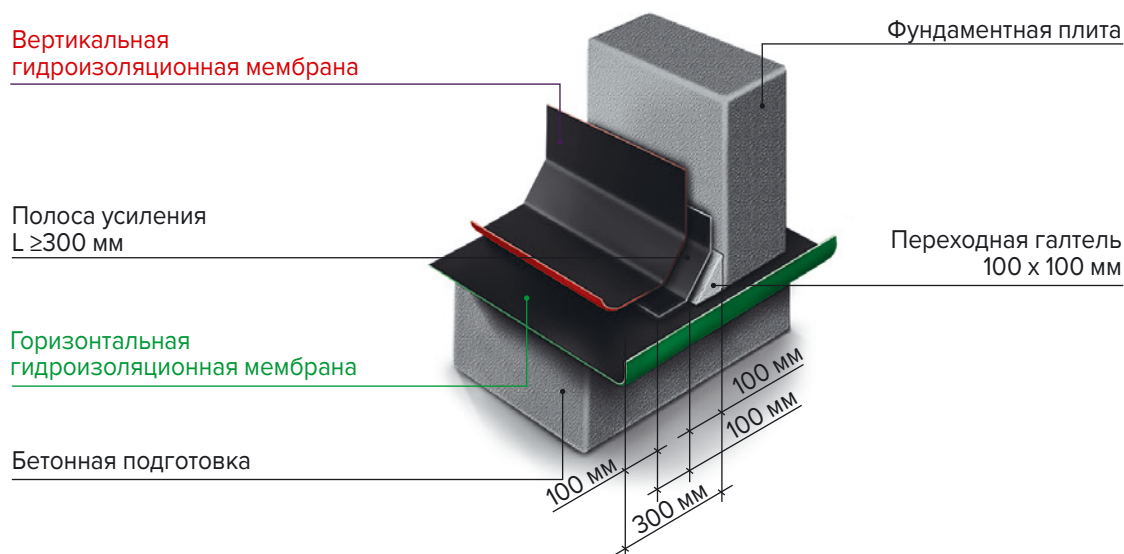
Раскладка рулонного материала на бетонной подготовке в зоне подошвы фундаментной плиты
